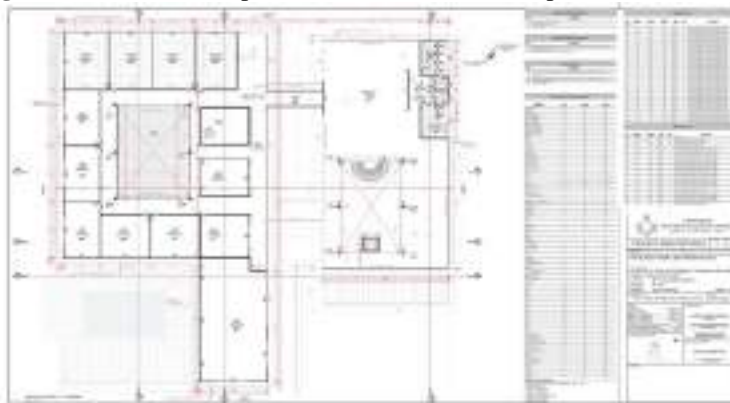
Prancha 06 - planta baixa técnica segundo pavimento e tabelas.
